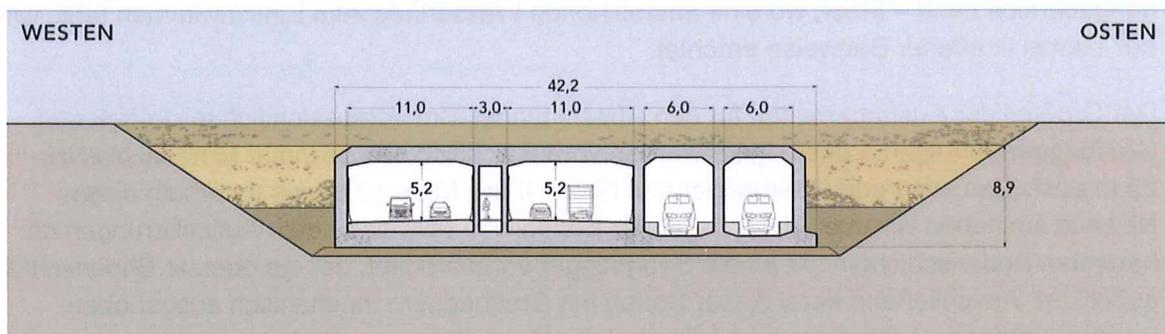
Querschnitt Absenktunnel – Standardelement (Maße in m)
